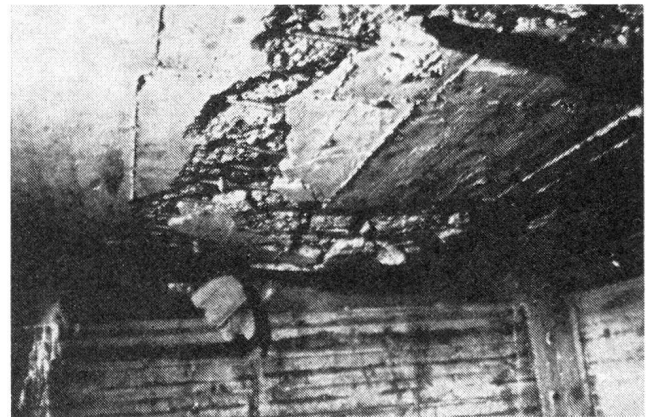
Durch Fallasten entstandene Absprengung auf der Unterseite einer Betondecke
